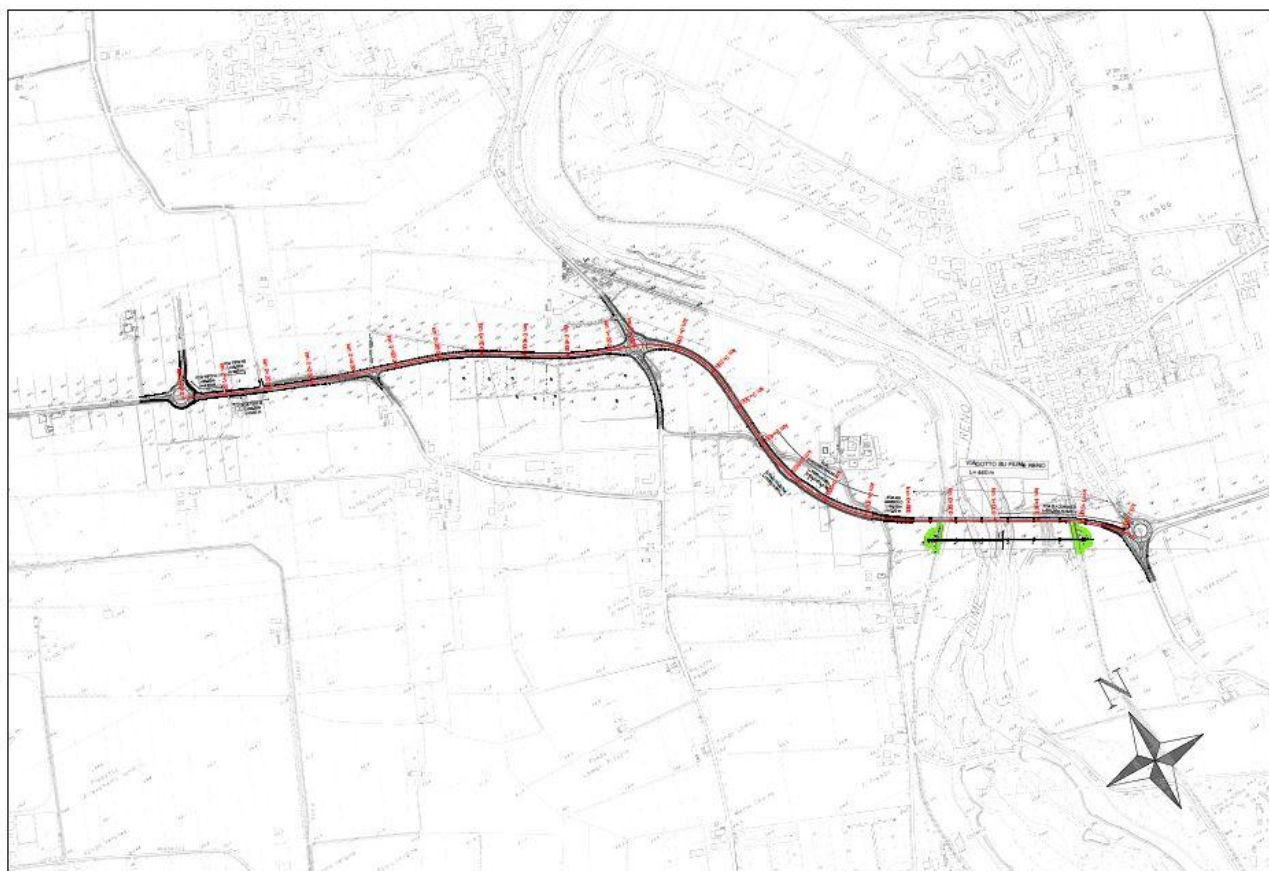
Planimetria dell'area di intervento Tratta B.
